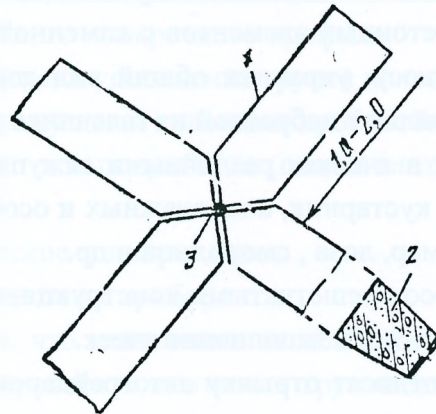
Схема соединения диагональных сборных бетонных элементов: 1 – диагональный элемент; 2 – поперечное его сечение; 3 – металлический штырь.
